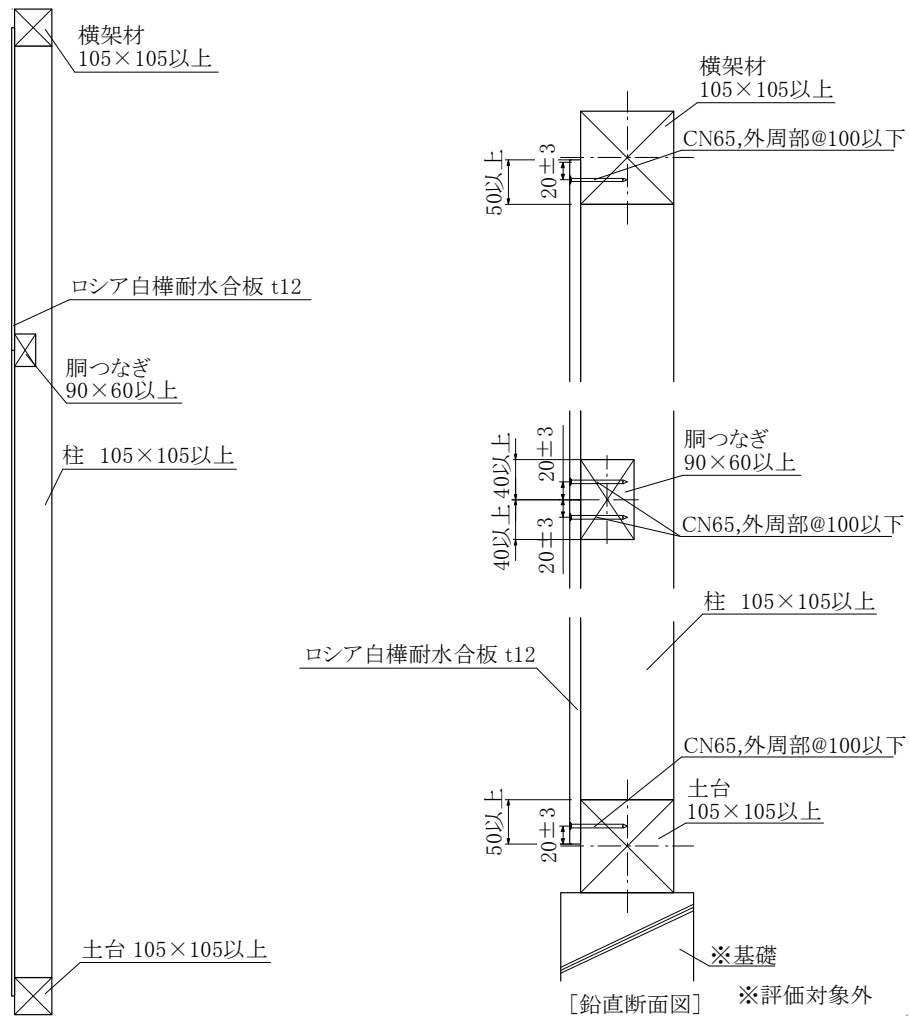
施工図 [鉛直断面] (寸法単位 : mm)
